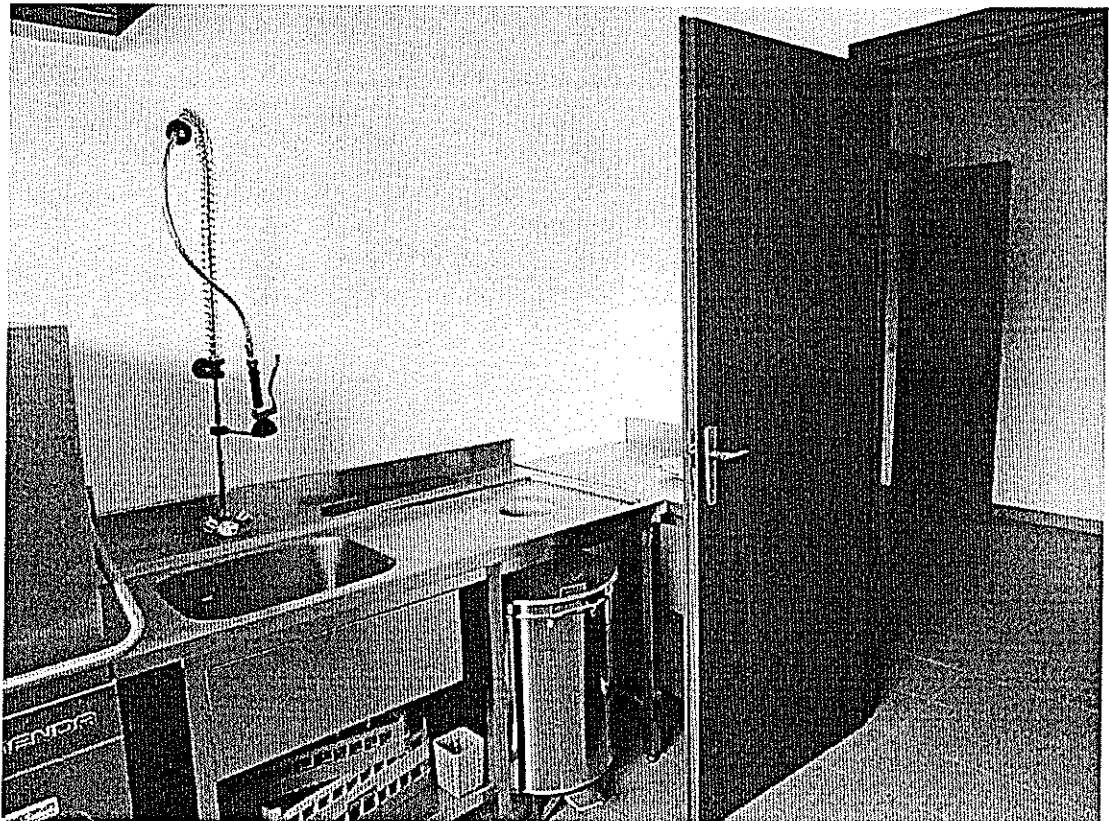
Lavaggio stoviglie del primo corpo di fabbrica – piano terra.
